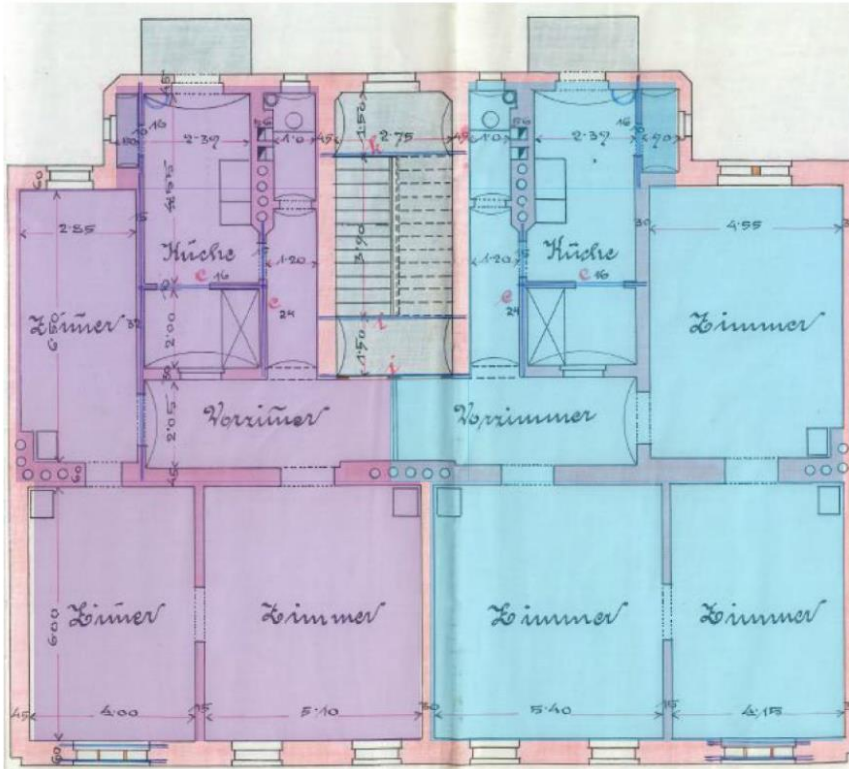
Grundriss eines Innenstadtpalais im zweiten und dritten Obergeschoß⁶²
